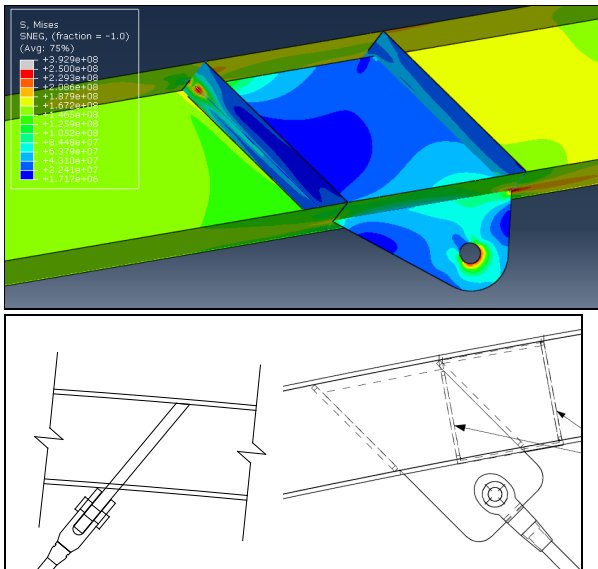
Izquierda: geometría proyectada. Derecha: geometría construida.
